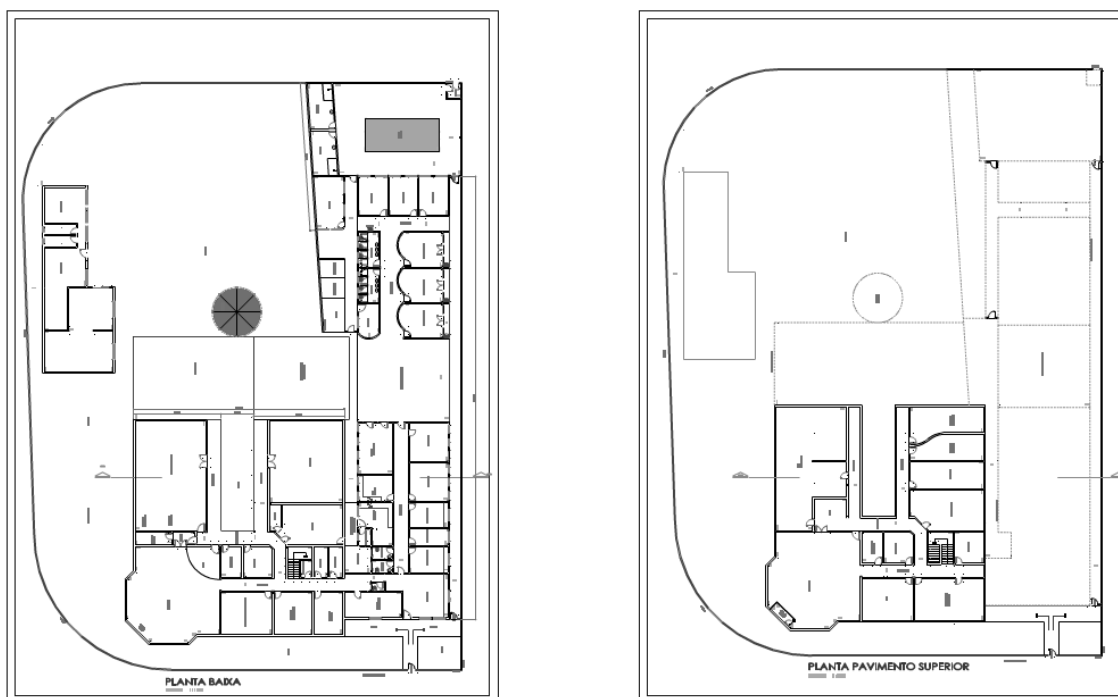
Planta baixa da sede da Fundação Síndrome de Down
